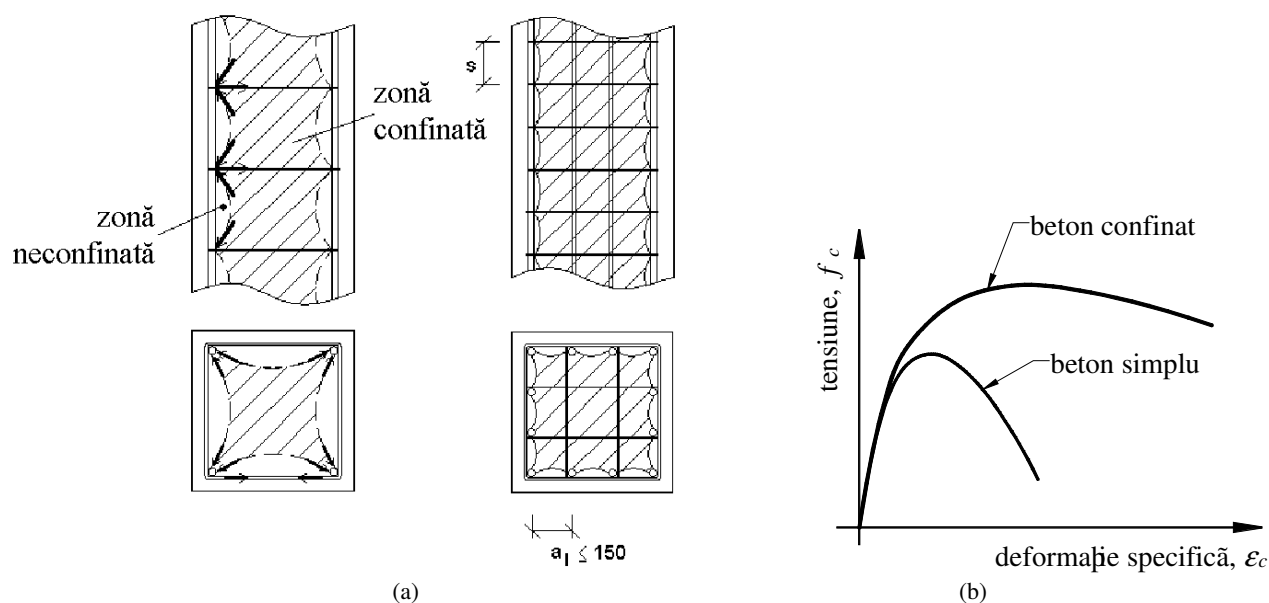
Confinarea betonului (a) și efectul confinării asupra relației tensiune – deformație specifică (b) după Paulay și Priestley, 1992.
